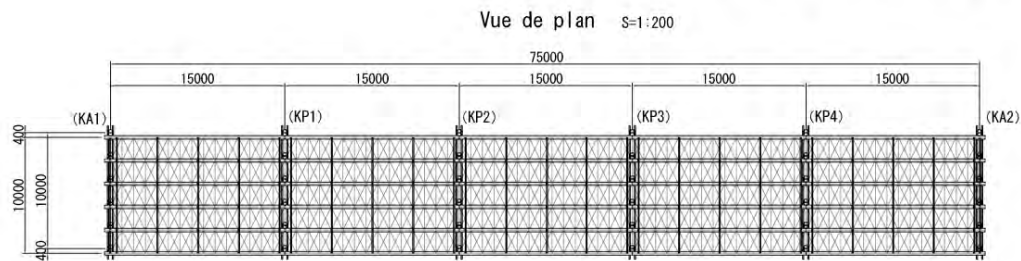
Plan général de l'ensemble du pont provisoire
